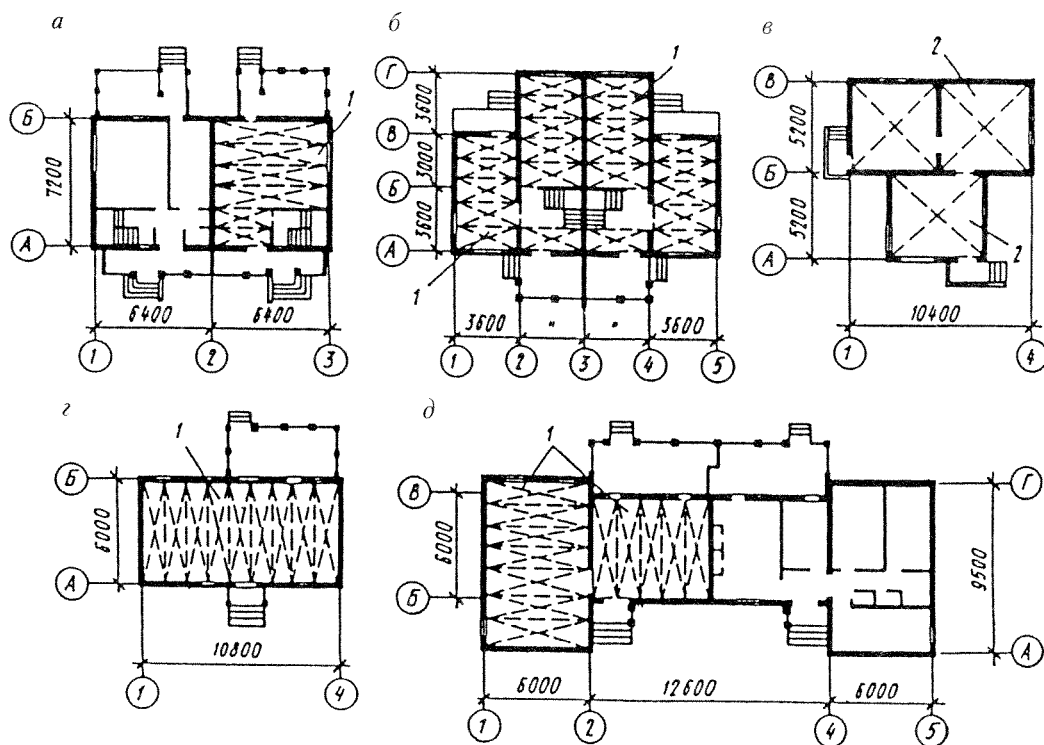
Планы конструктивных схем стеновых оснований малоэтажных зданий: а — с поперечными несущими стенами и большим шагом; б — то же, с малым шагом; в — коробчатый остов; г — с продольными несущими стенами; д — с несущими стенами в двух направлениях: 1 — балочный или плитный настил перекрытия; 2 — настил перекрытия на комнату с опиранием по всему периметру
